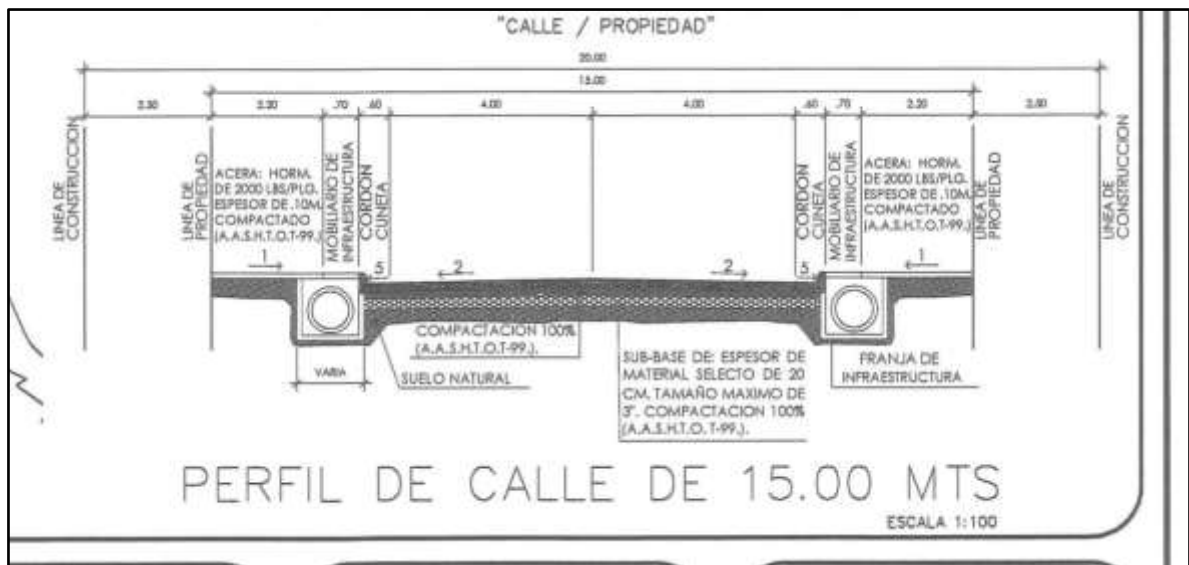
Detalles del perfil de las calles - planos del proyecto.
